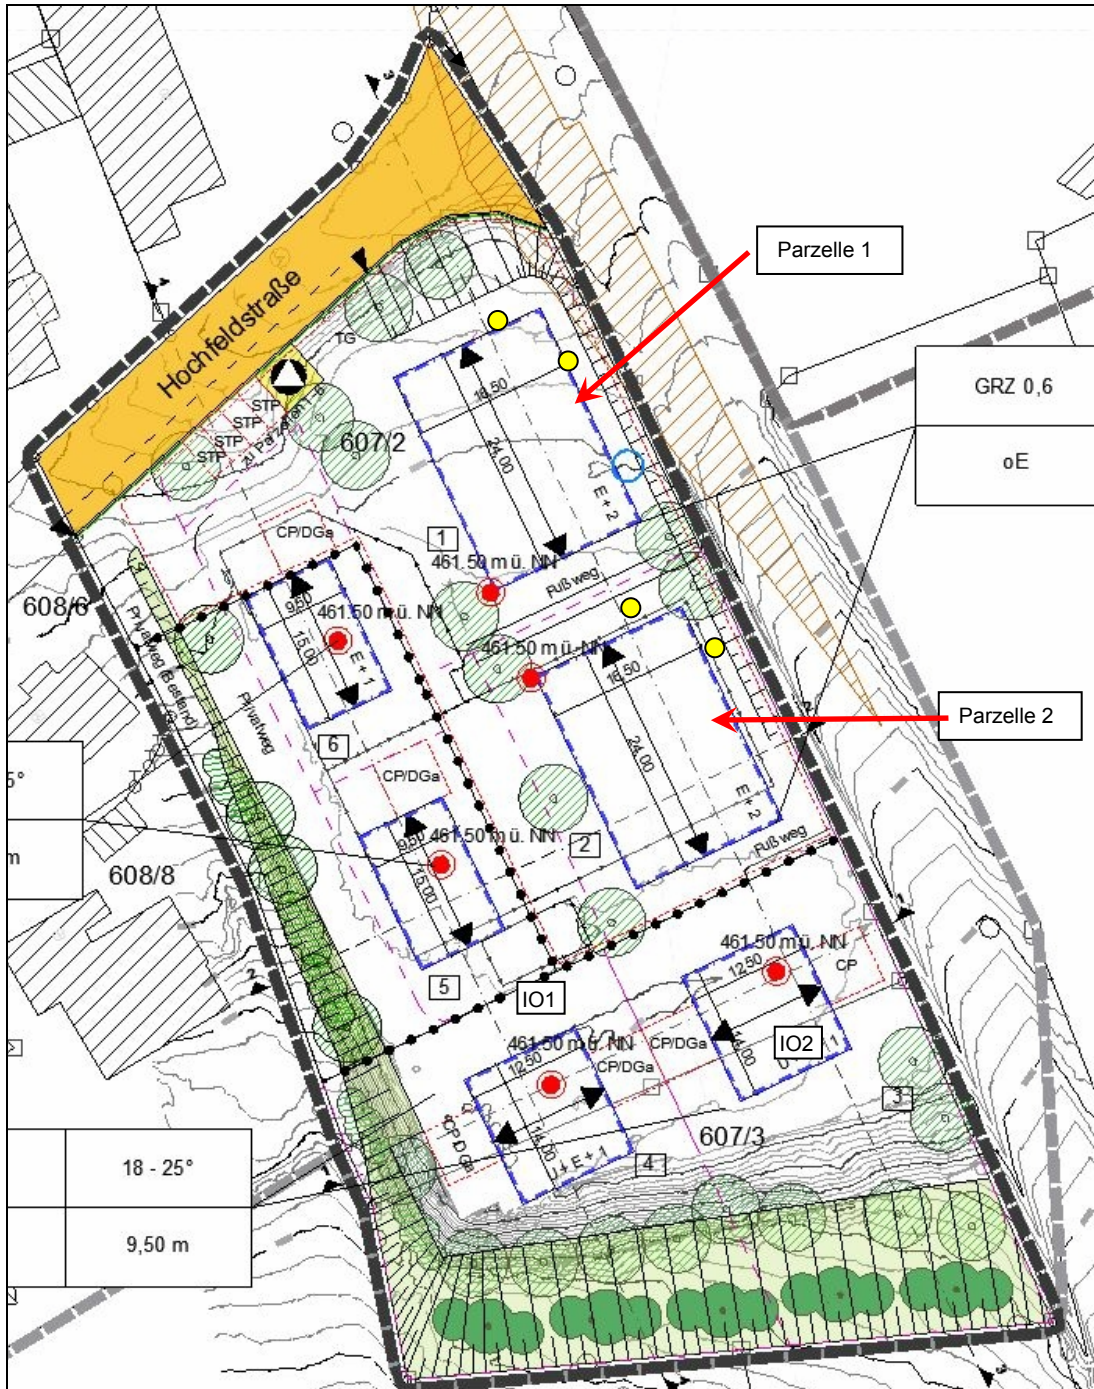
Entwurf Lageplan z. Bebauungsplan 134 (Ausschnitt) ● Immissionsorte
